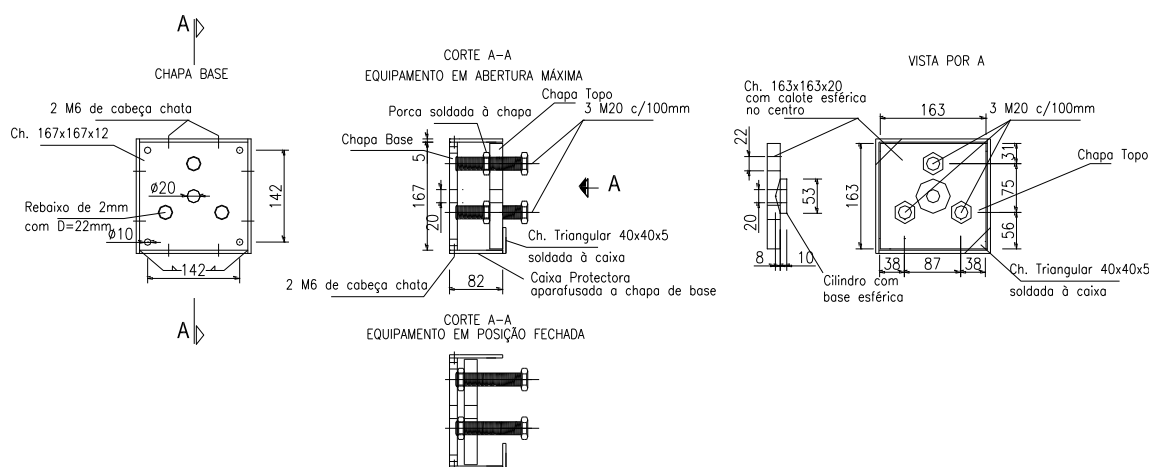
Detalhes do sistema de aplicação de pré-esforço com actuador mecânico tipo B. (desenho sem escala e com dimensões em mm)
